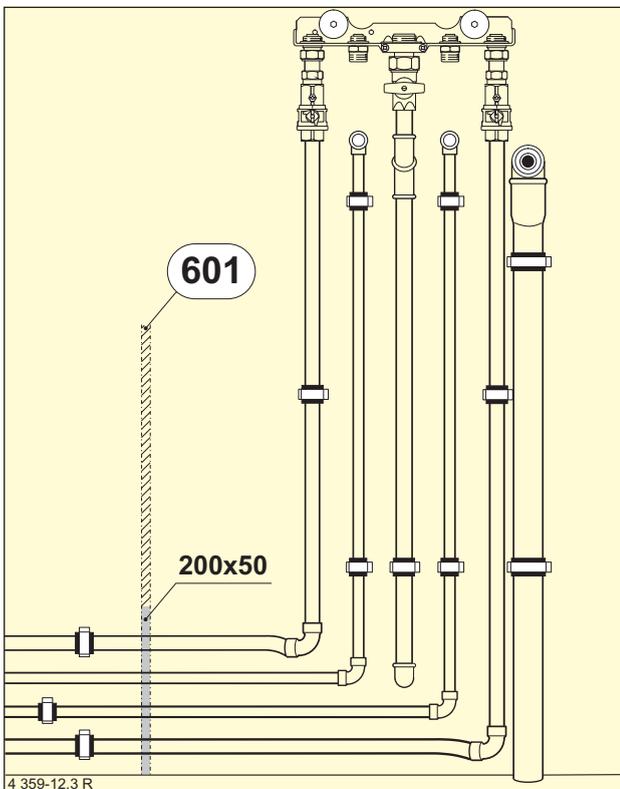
Bauseitige Aufputzverrohrung mit 60 mm Wandabstand
